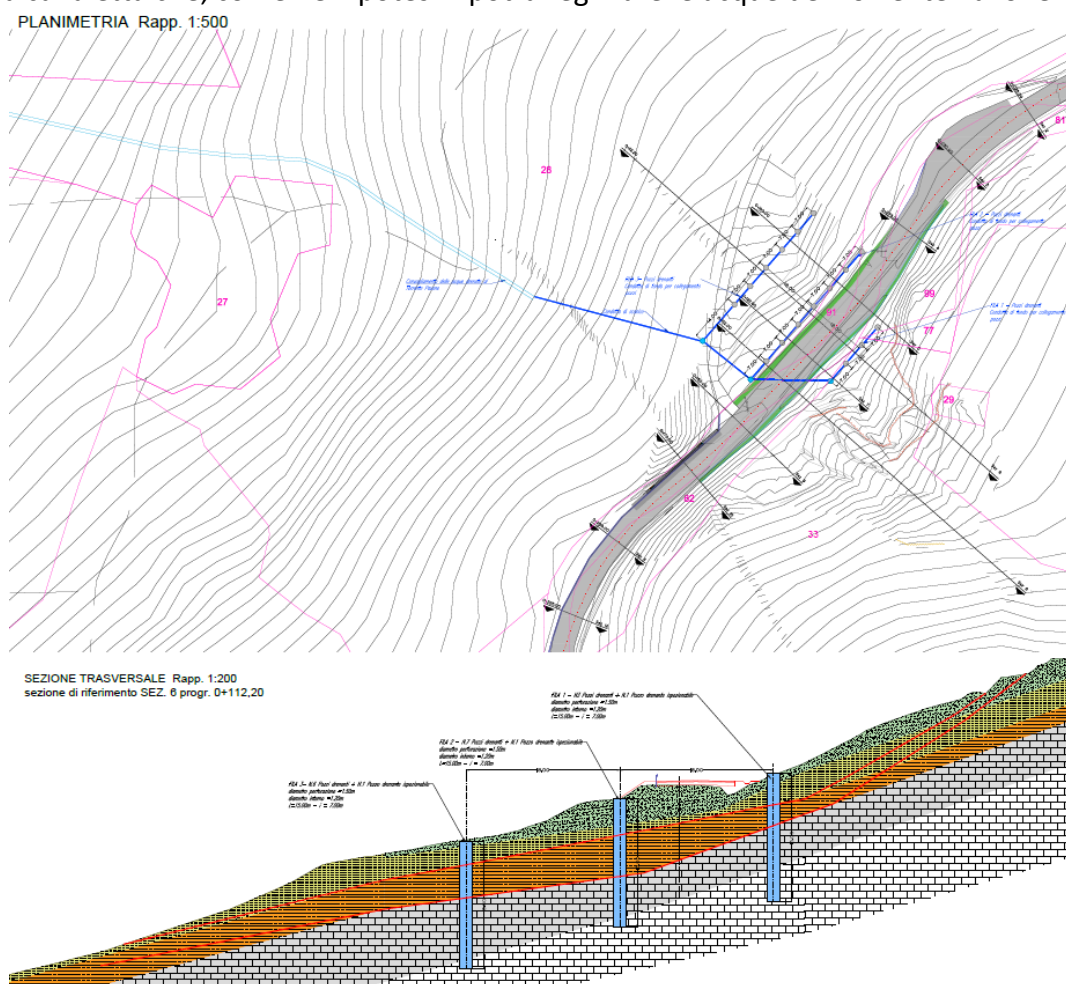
Planimetria e sezione della progettazione "intervento ipotesi 1"
